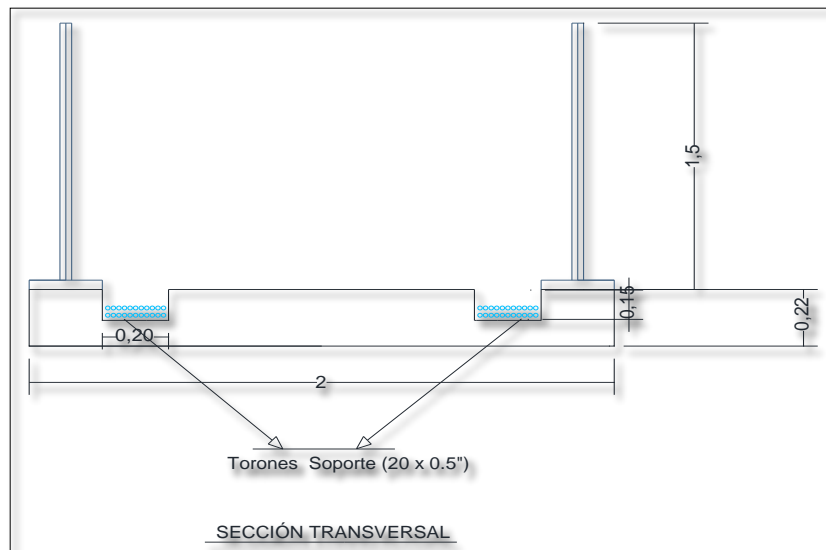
Sección transversal. Fuente: Elaboración propia
